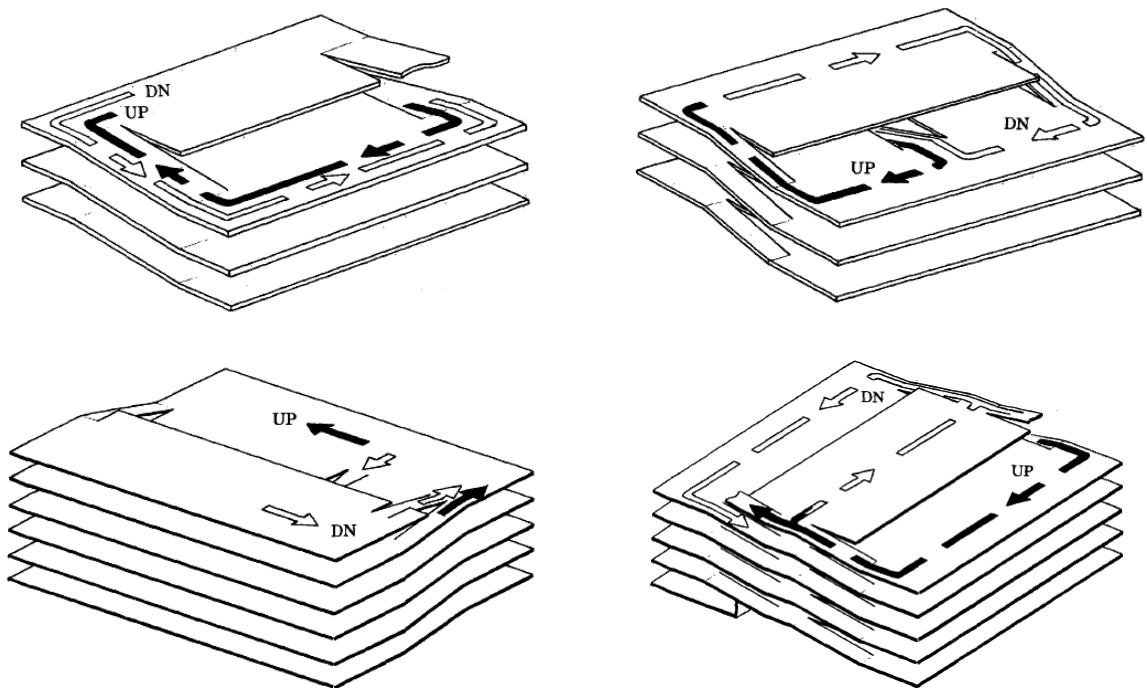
Exemplos de layout com sistema de pavimentos escalonados, segundo Weant (1978)
